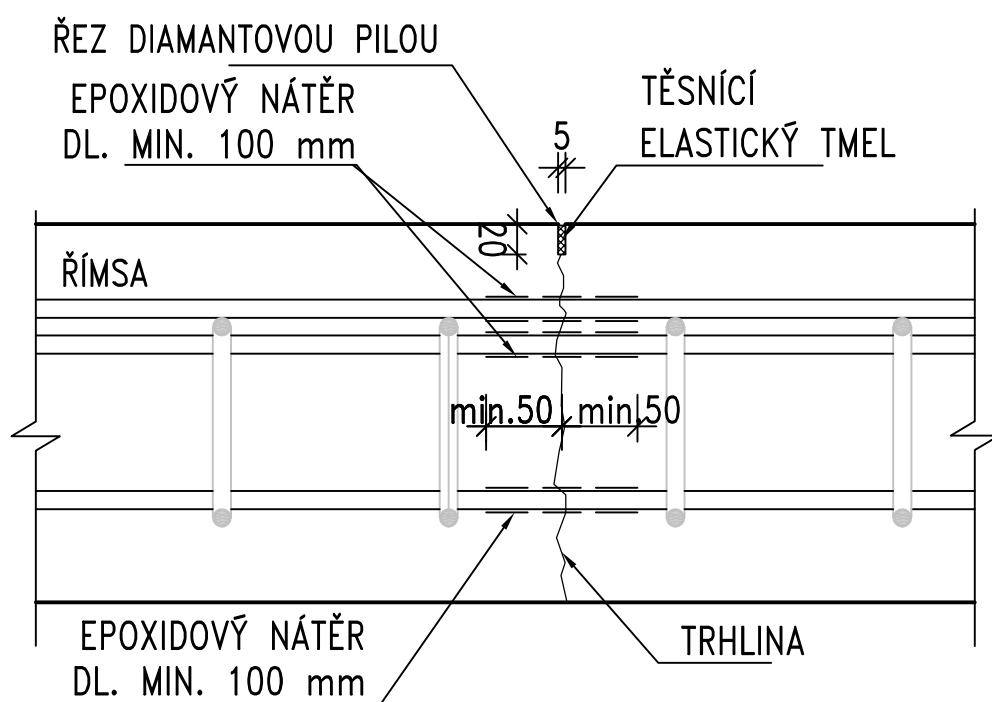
DETAIL SPÁRY MEZI PREFABRIKÁTEM
